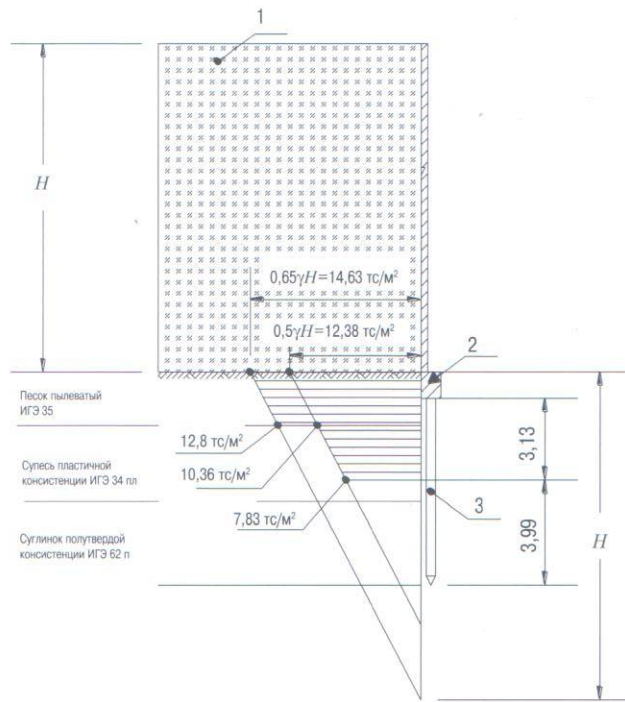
Эпюра распределения дополнительного горизонтального давления на сваи от веса подходной насыпи: 1 – армогрунт; 2 – ростверк фундамента открылка; 3 – забивные сваи 0,35x0,35 м
